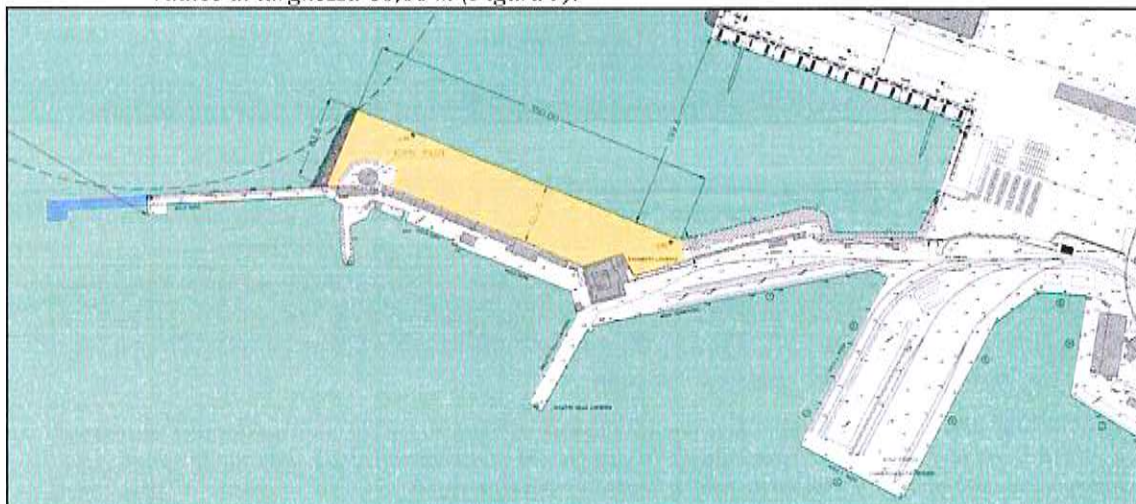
Planimetria generale di progetto SOLUZIONE 1 senza retrobanchina.
